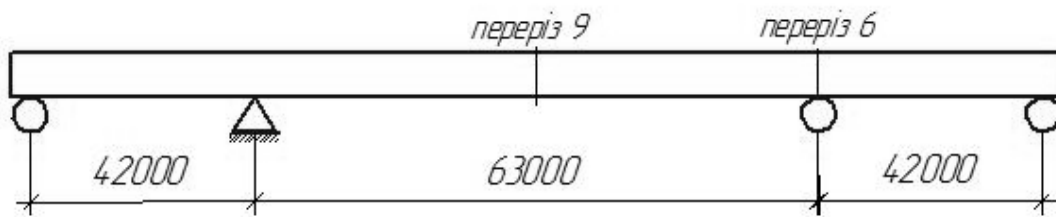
Нерозрізна залізобетонна прольотна будова
